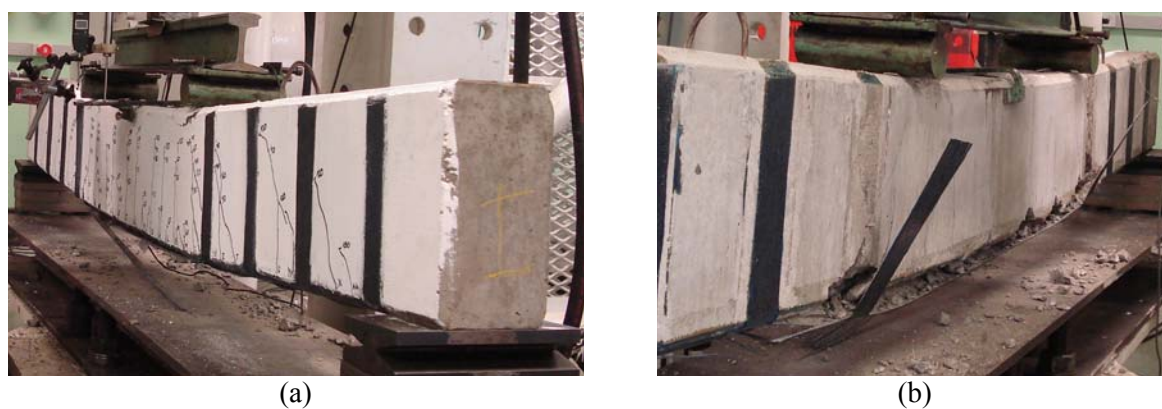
Viga VFC_02: (a) Viga momentos antes da ruptura; (b) Detalhe da ruptura do reforço no vão central da viga.
